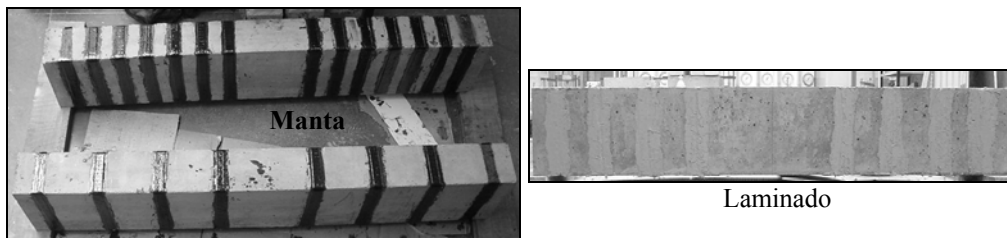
Sistema curado in situ e sistema pré-fabricado (aplicação do reforço).
